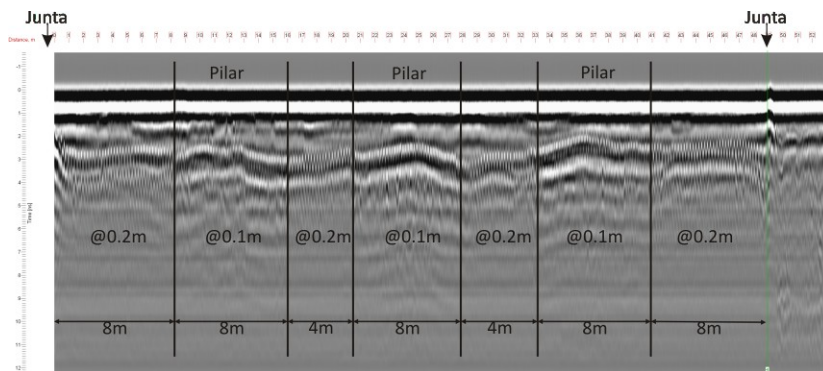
Radargrama ilustrando um perfil longitudinal para a detecção da espessura do pavimento e da armadura transversal ao longo do viaduto (entre as juntas nos encontros).
